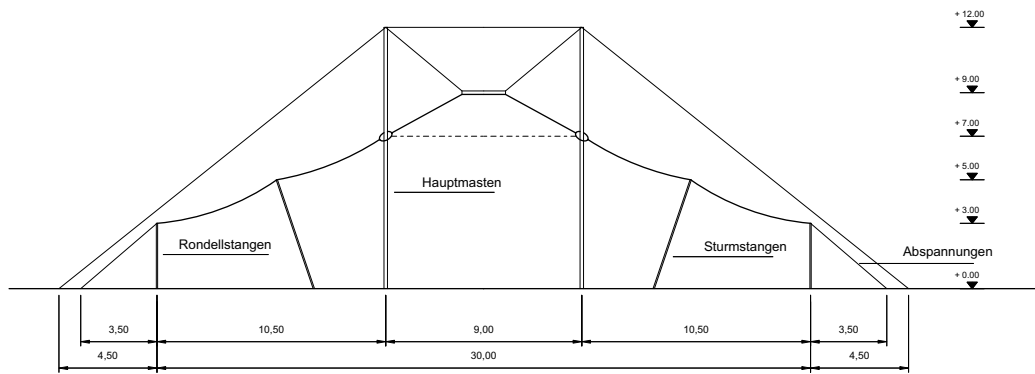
Chapiteau, Schnitt Grundriss, Aufbausritte
